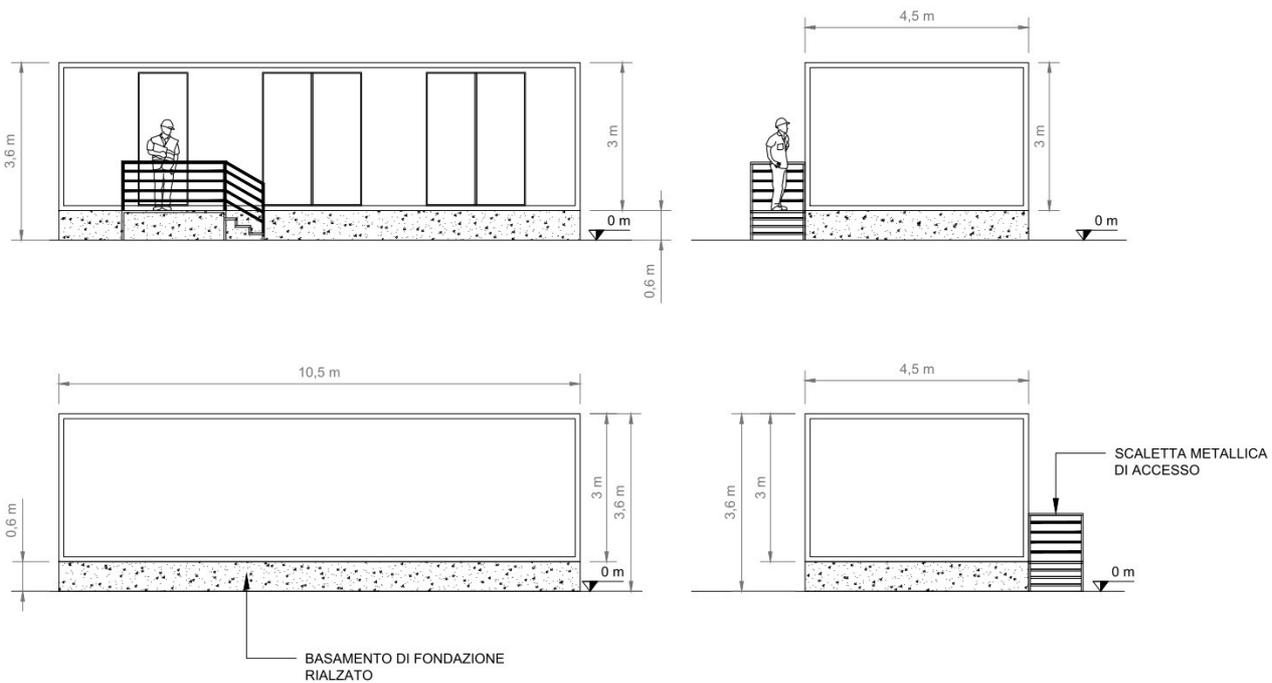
Shelter prefabbricato metallico – prospetti e sezioni
